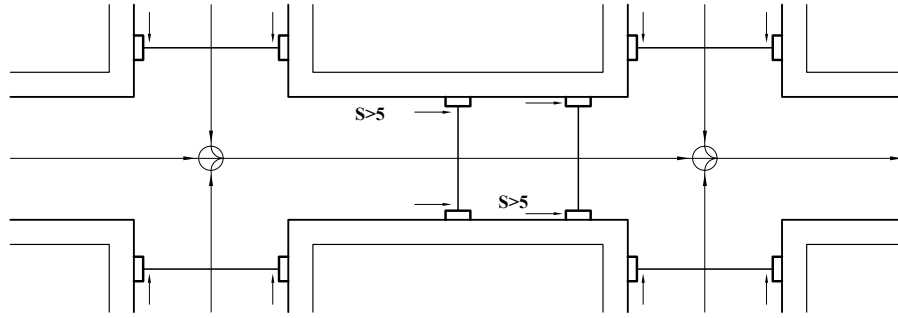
Ubicación de coladeras longitudinales de banqueta.
